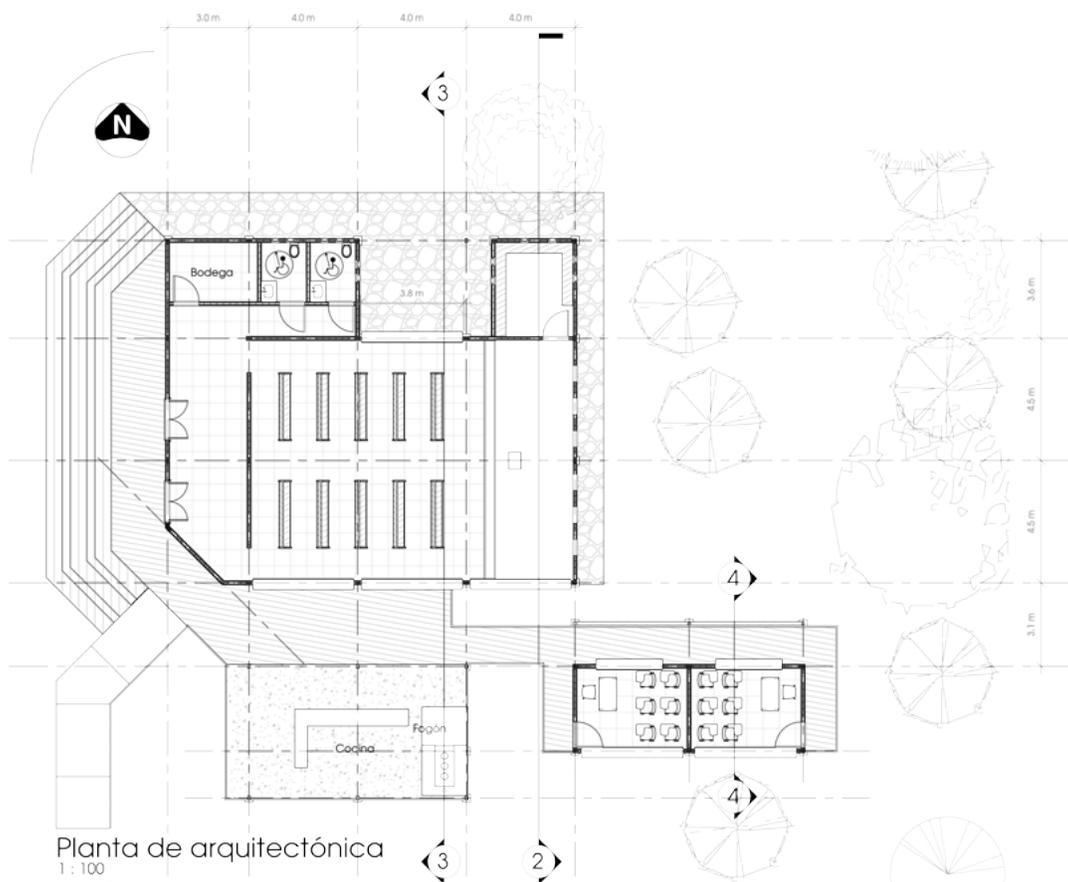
Planta de la propuesta de diseño de la iglesia evangélica para Parcelas de Rancho Coco. Fuente: Elaboración propia.
